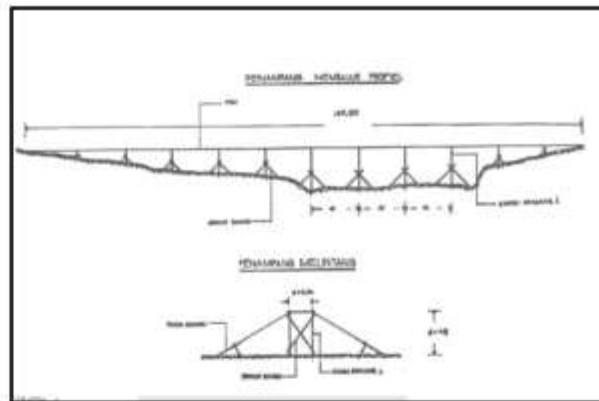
Pemasangan *Bouw plank* Dam Pengendali
